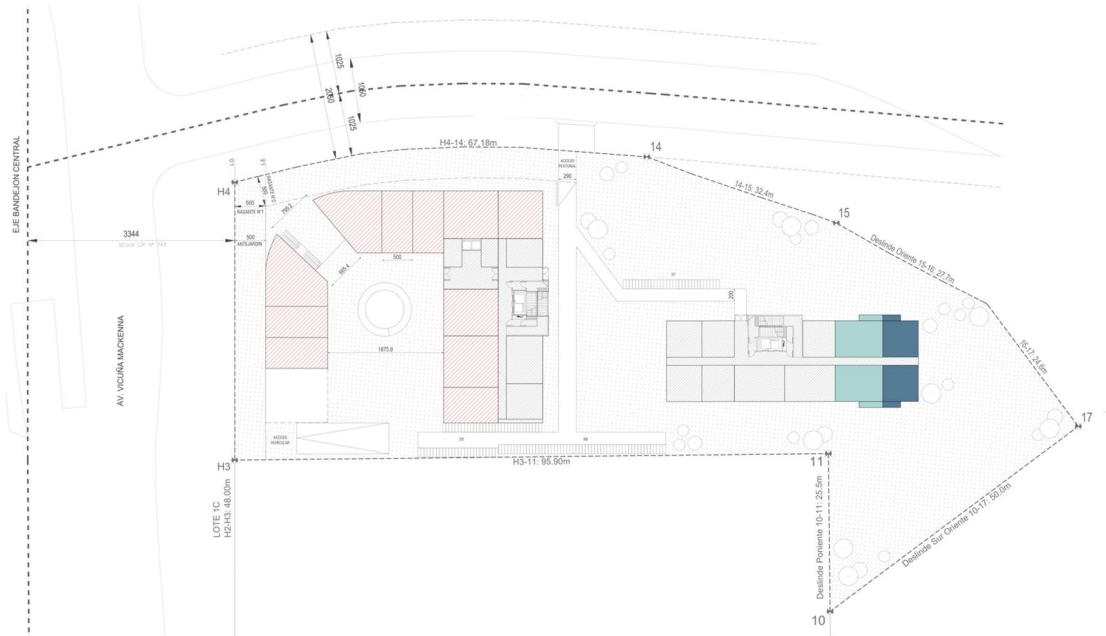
Plano 1° piso. Fuente: Elaboración propia
